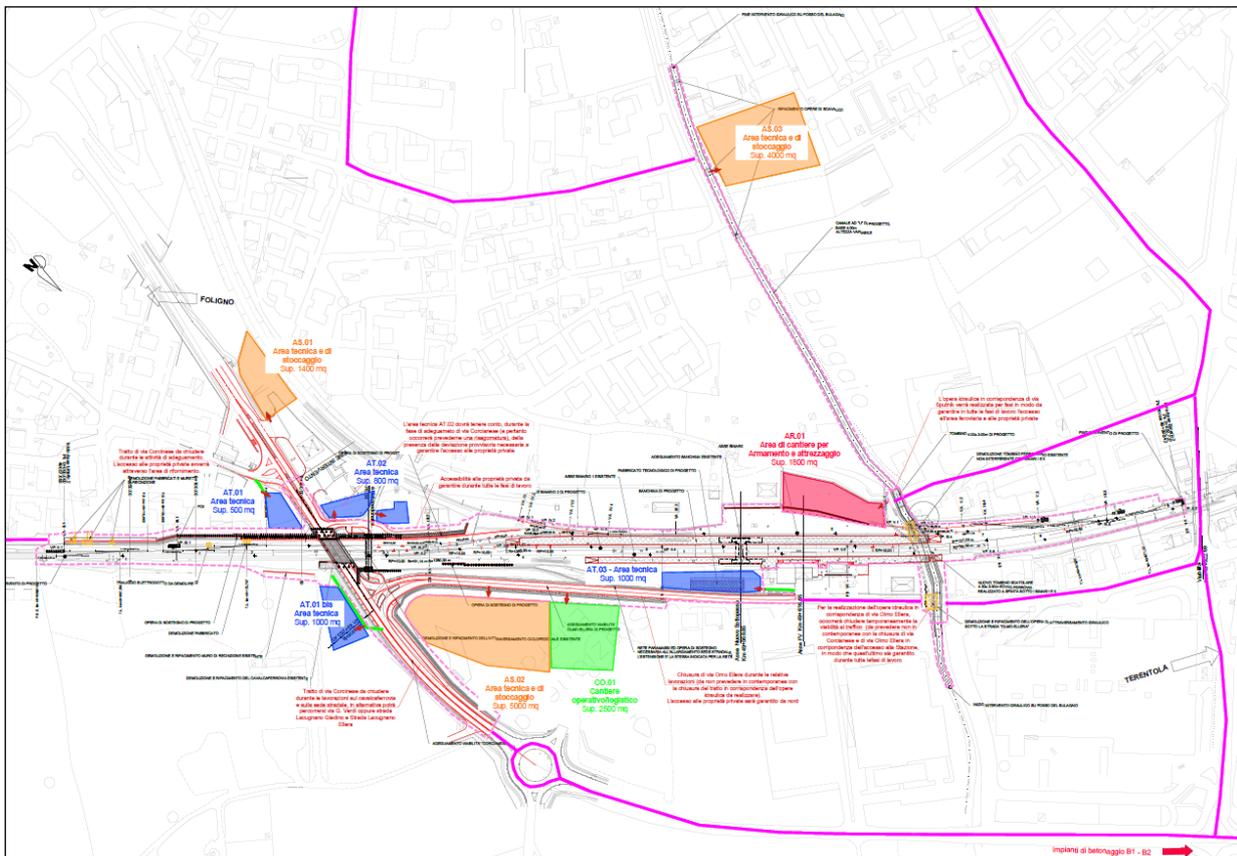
Planimetrie dei cantieri e viabilità di accesso alle aree di cantiere (in verde pista di cantiere)
